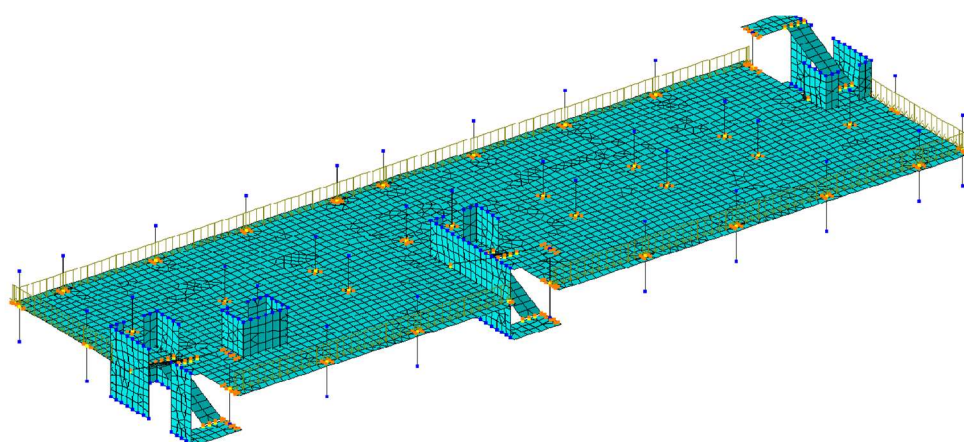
Нагрузка от веса наружного стенового ограждения
